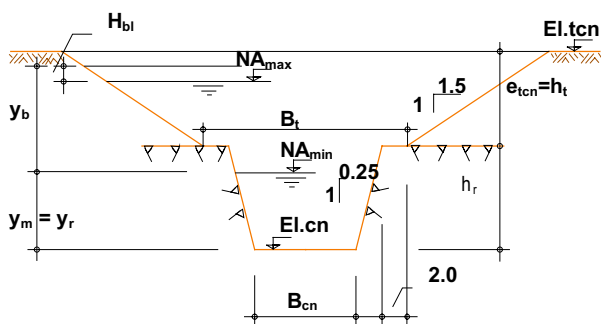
Seção transversal típica de canal de adução em rocha (caso 2).
